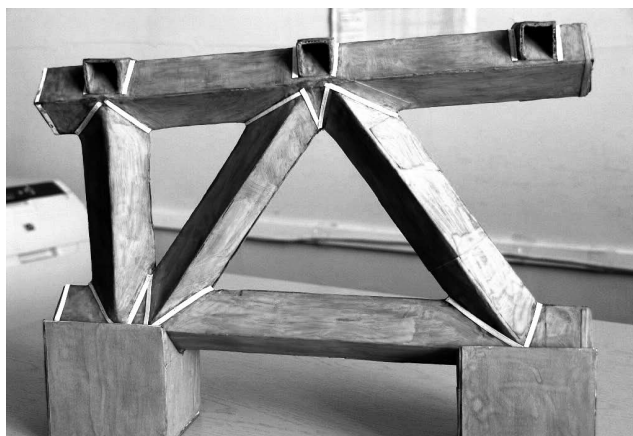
Макет фрагмента бесфасоночной фермы из квадратных труб на ребро
